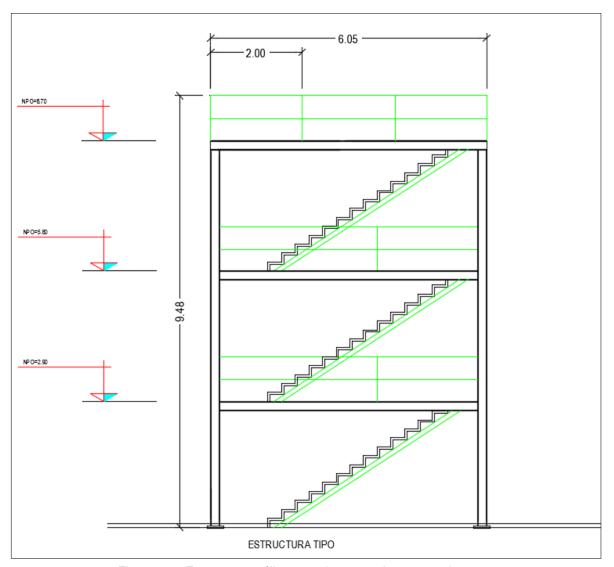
Estructura metálica para el acceso a los contenedores
